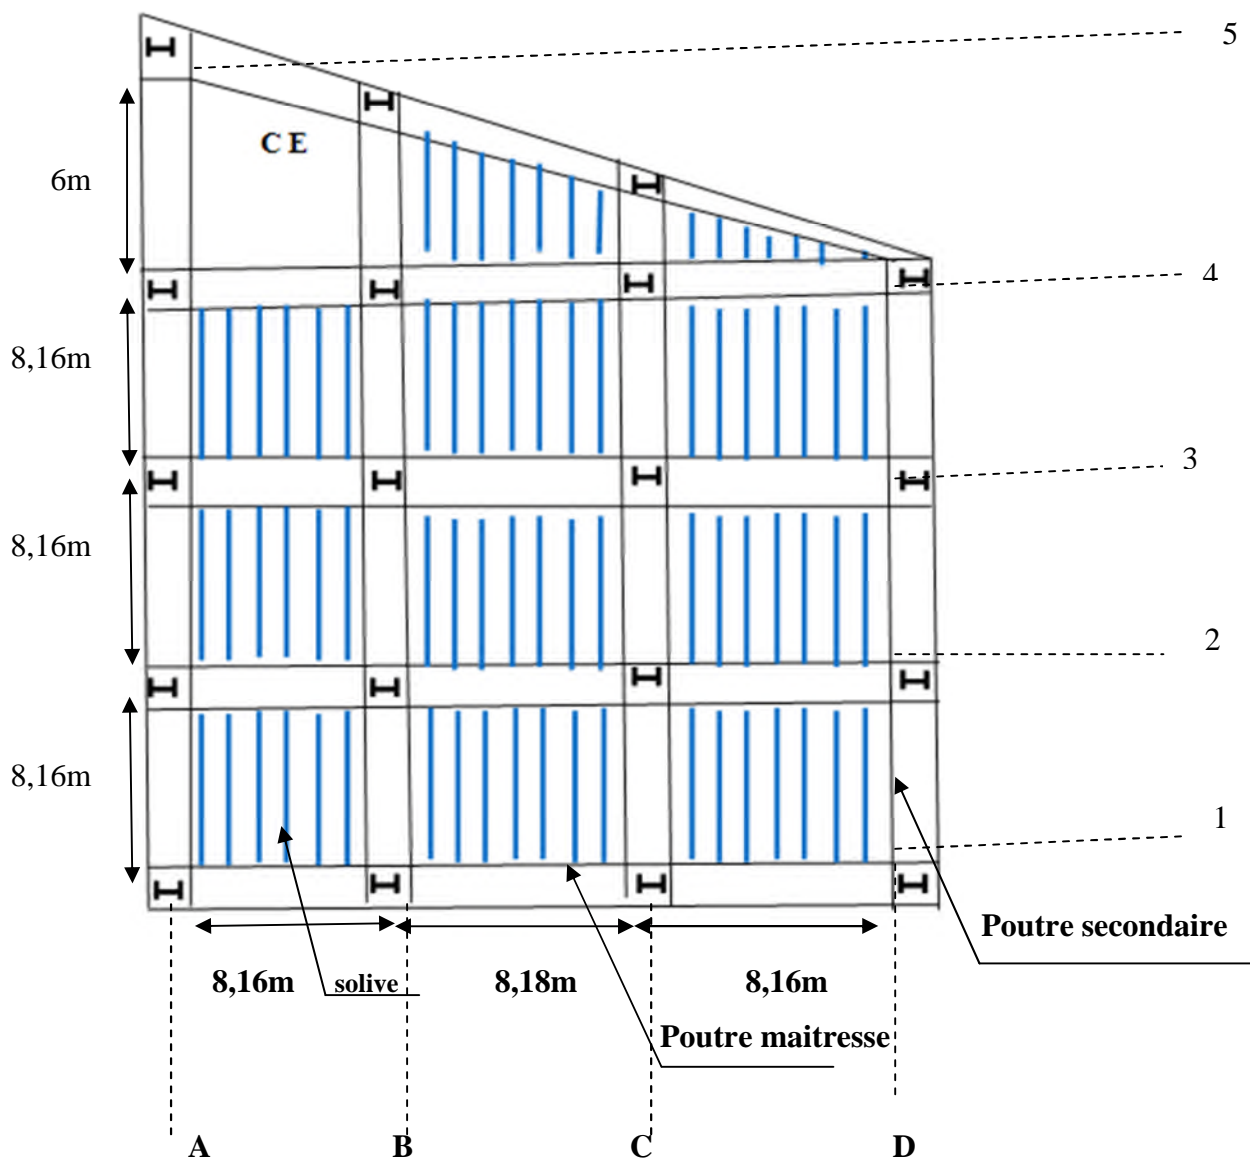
Plan de repérage et d'orientation des poteaux et disposition des solives.
